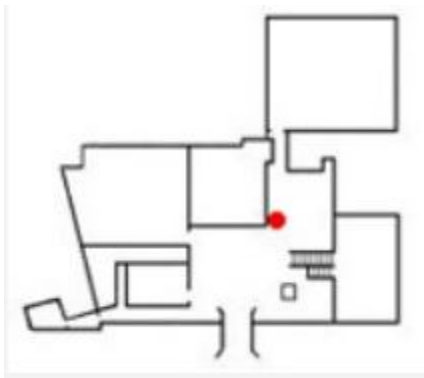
Grundriss der VBF Hamburg⁸⁷
